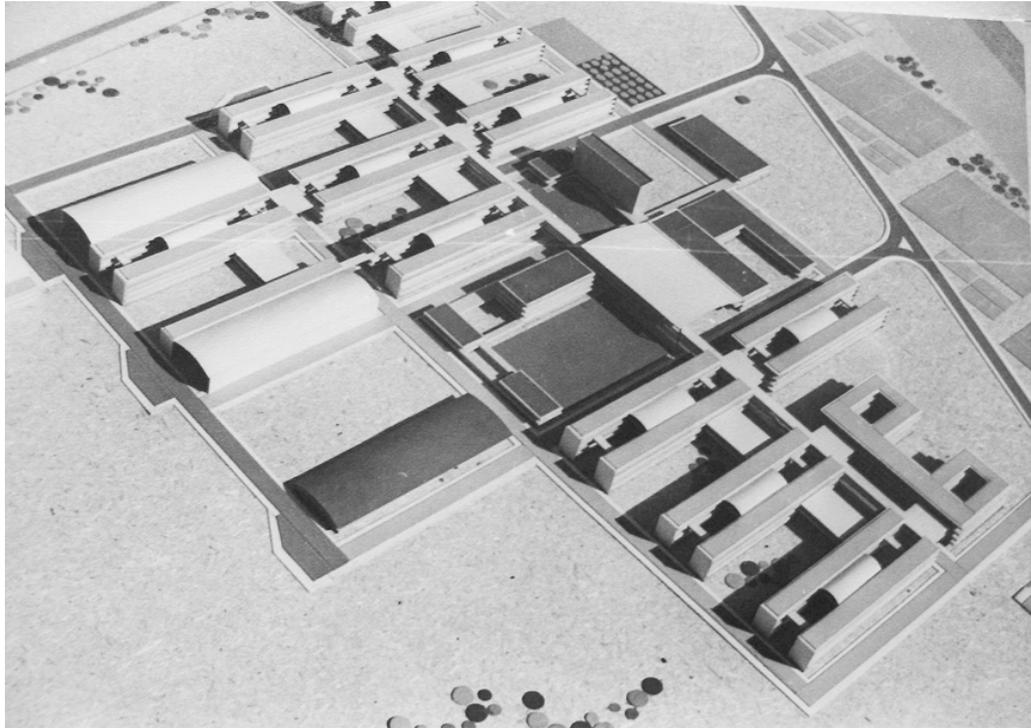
Foto de la maqueta del Campus de la UNL s/f.
